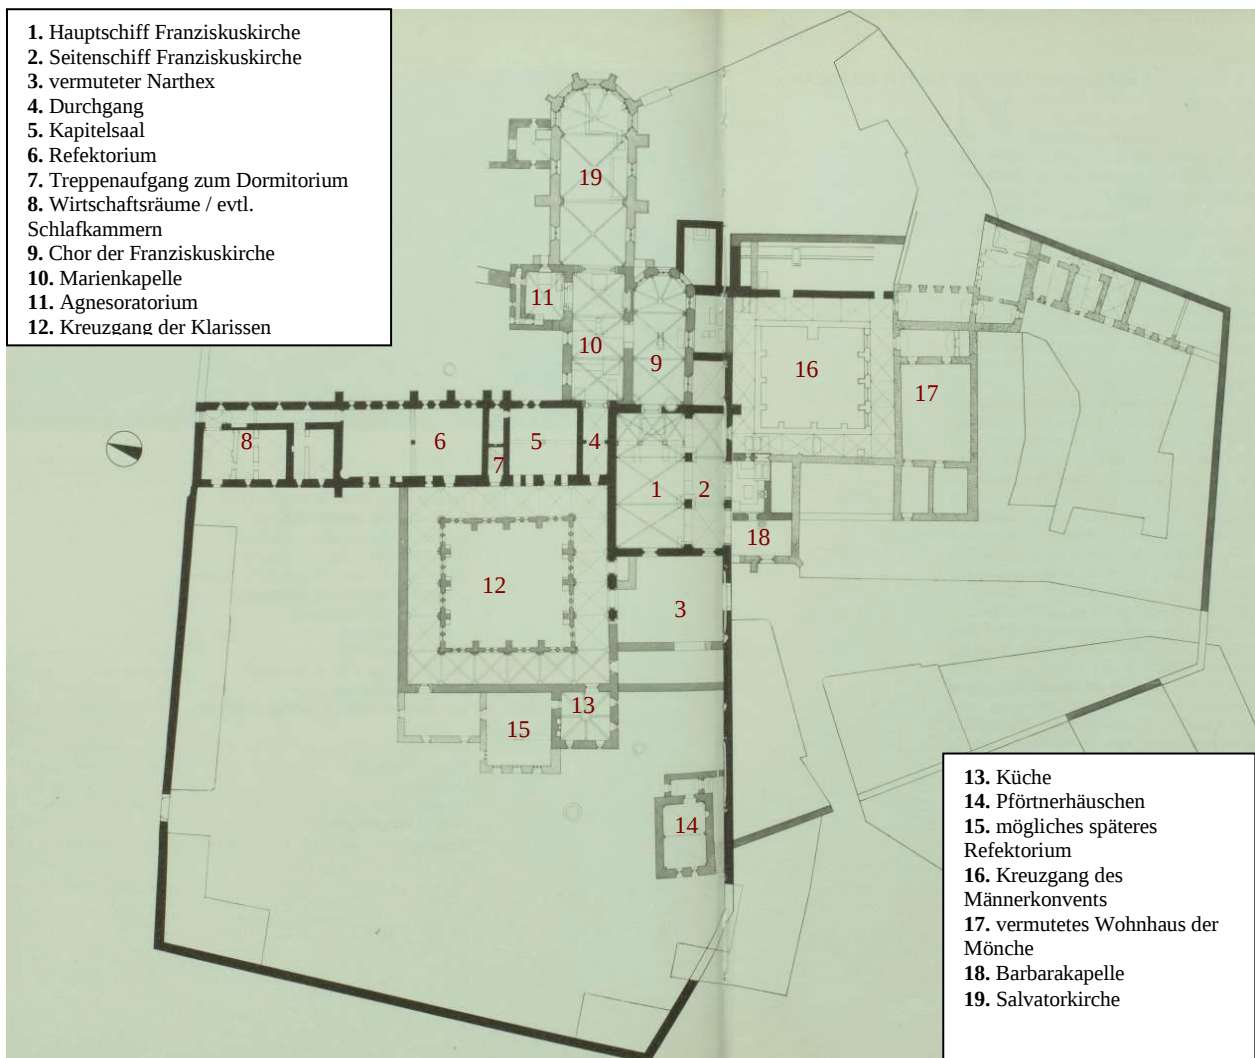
Grundrissplan, Agneskloster, Prag
